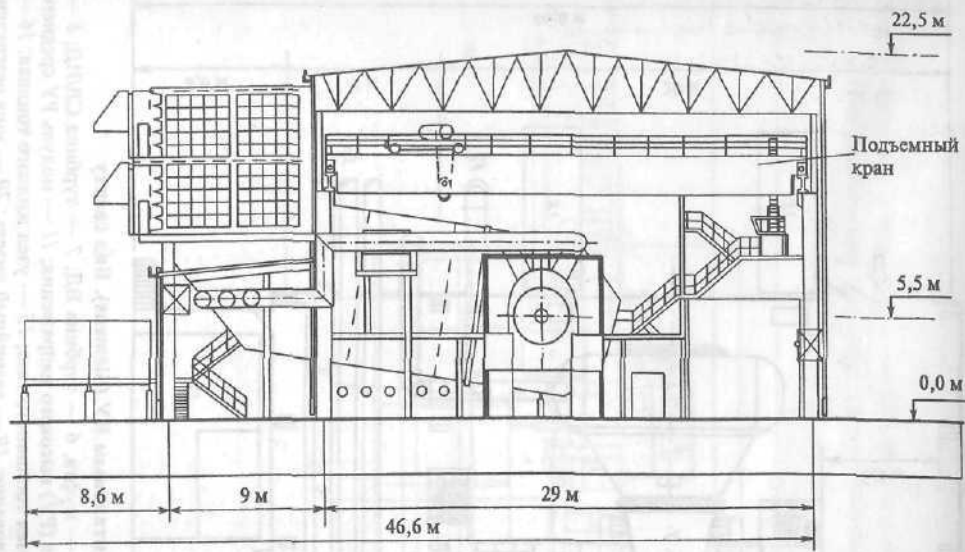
Компоновка главного корпуса одновальной ПГУ мощностью 385 МВт (Siemens). Поперечный разрез
